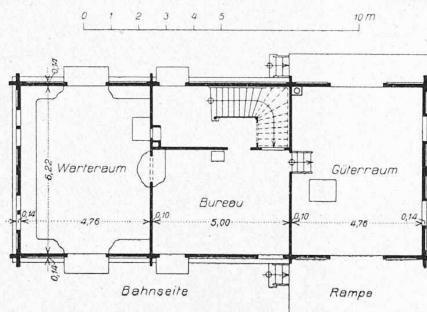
und 5. Typus der Zwischenstationen Ilanz-Disentis. — Grundrisse 1:250.
